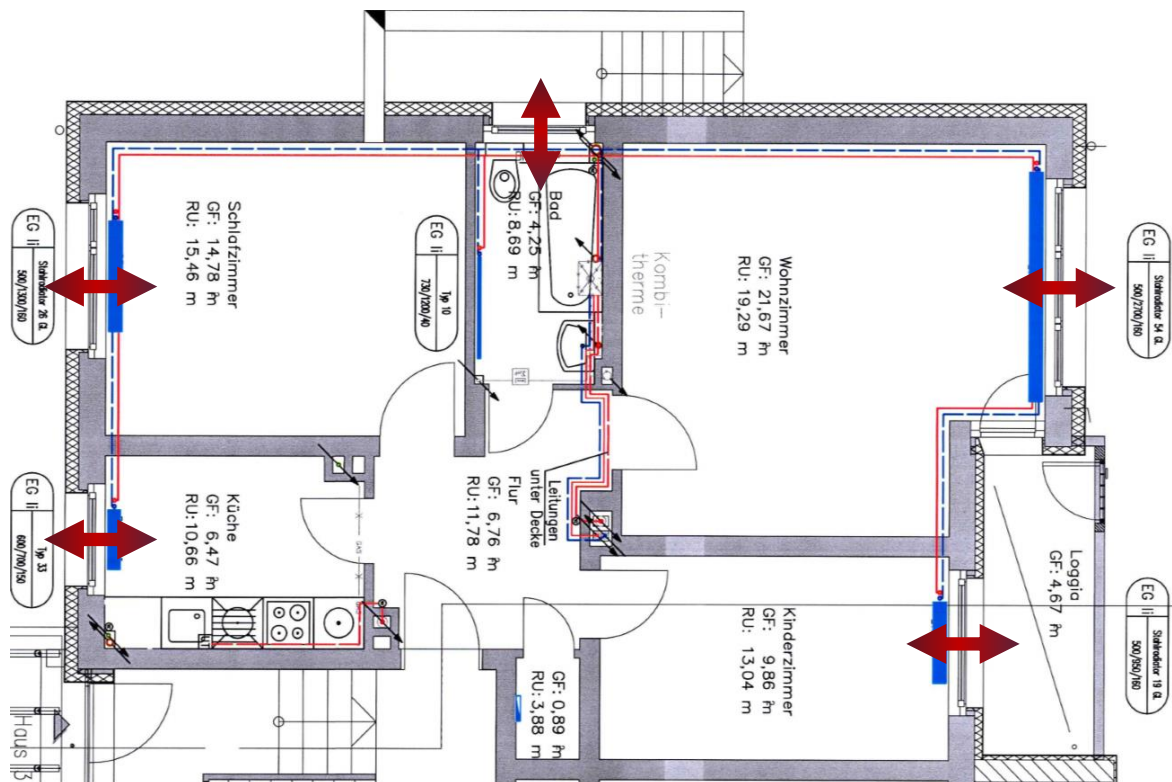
Grundrissausschnitt EG eines Mehrfamilienhauses mit Außenbauteil-Luftdurchlässen ALD, modifizierte Abbildung Firma Grundlach-Wohnungsunternehmen.
